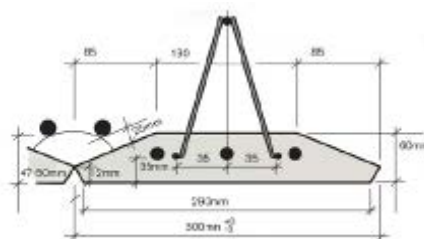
Залізобетонні плити незнімної опалубки фірми «Hanson»
